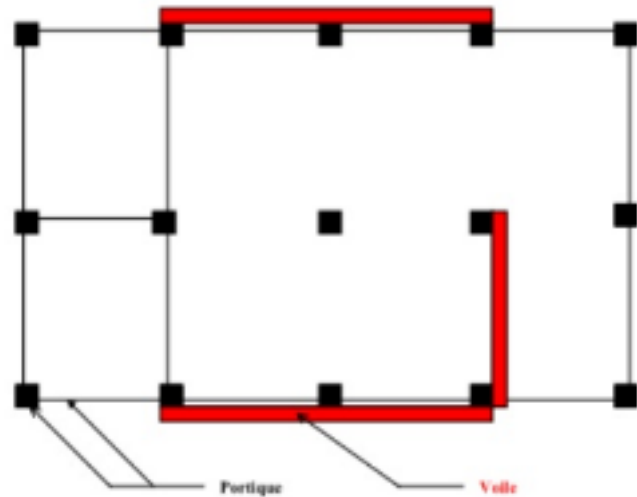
2:Schéma des structures mixtes avec des murs porteurs associés à des portiques
